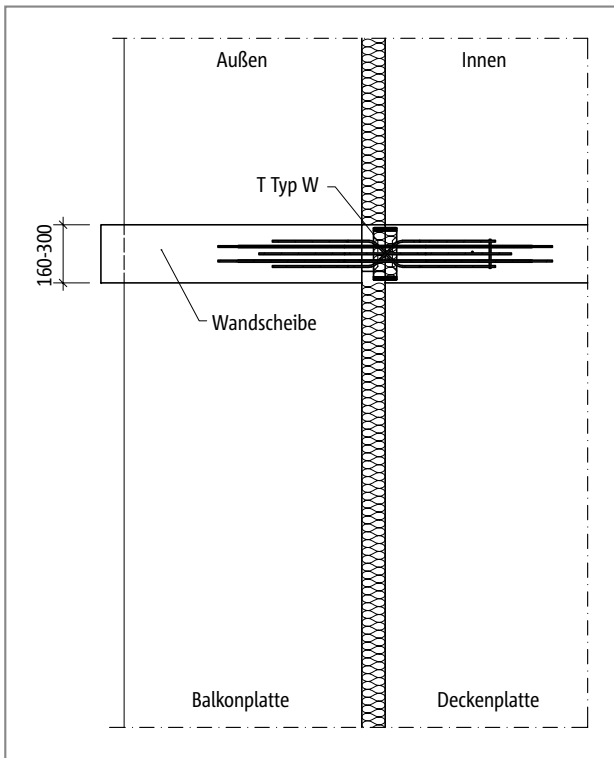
Schöck Isokorb® T Typ W: Grundriss; Balkonkonstruktion mit wärmegeämmten tragenden Wandscheiben
